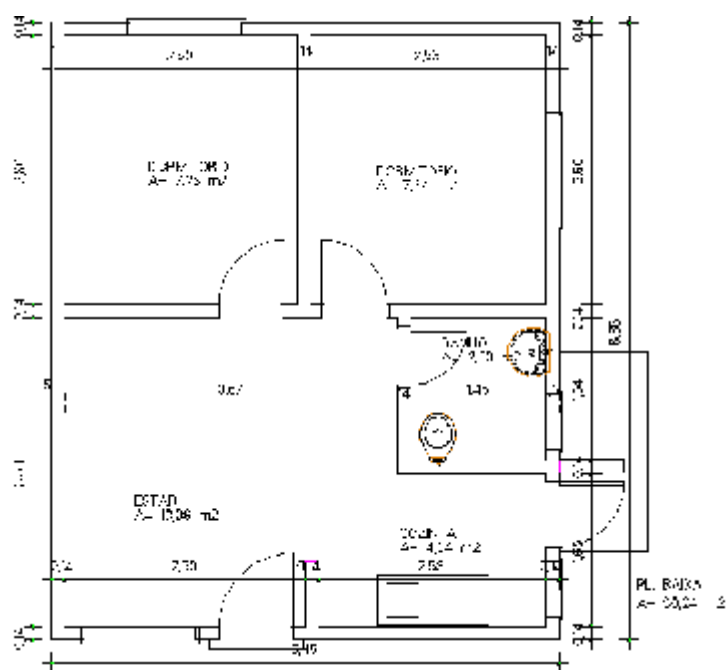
Planta Baixa Embrião de 02 dormitórios
